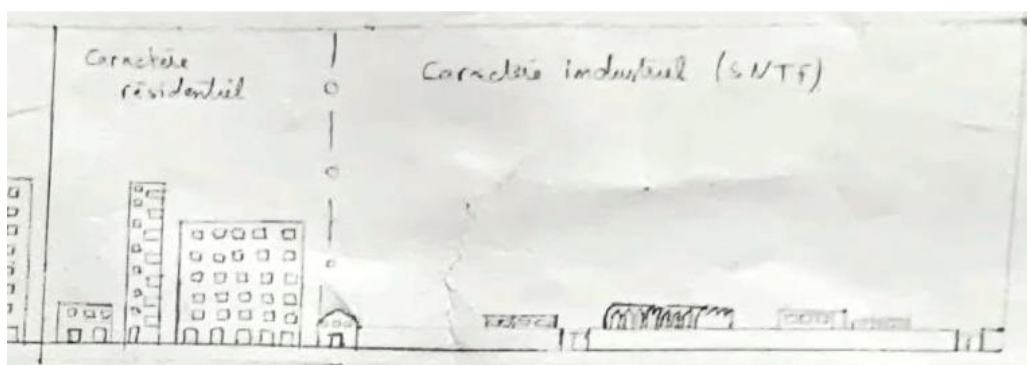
Façade nord de la rue Hassiba. (Source : auteur)
